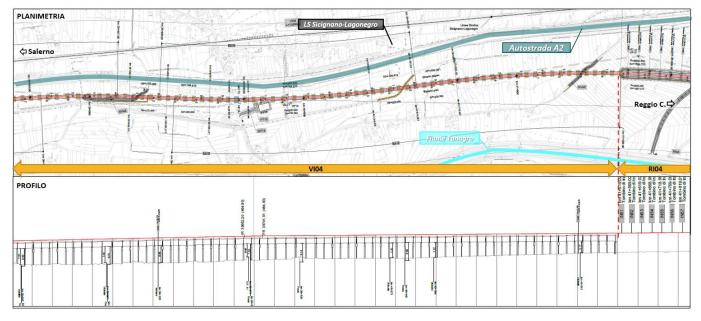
Planoprofilo di progetto da km 39+300 a km 41+486
